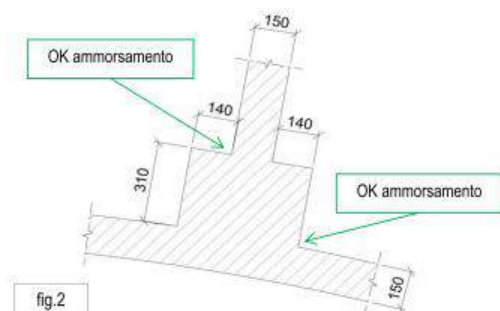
Primo ordine dei palchi: Muro sul perimetro della sala e pilastri della zona palchi (saggio T4)
